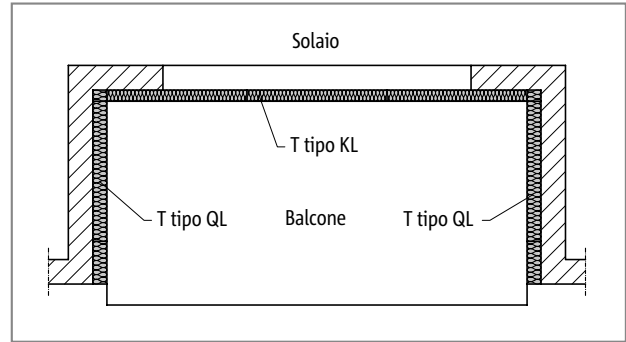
Schöck Isokorb® T tipo KL e tipo QL, balcone con tre appoggi
